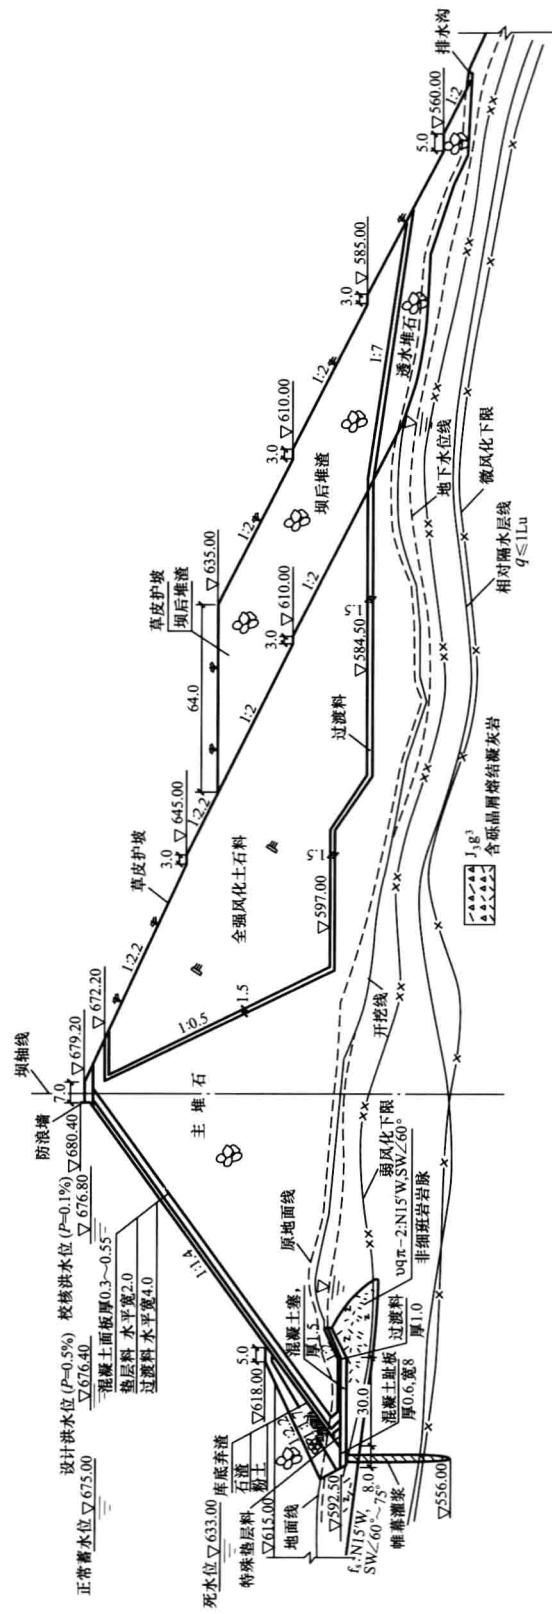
仙居抽水蓄能电站上水库混凝土面板堆石坝剖面图
